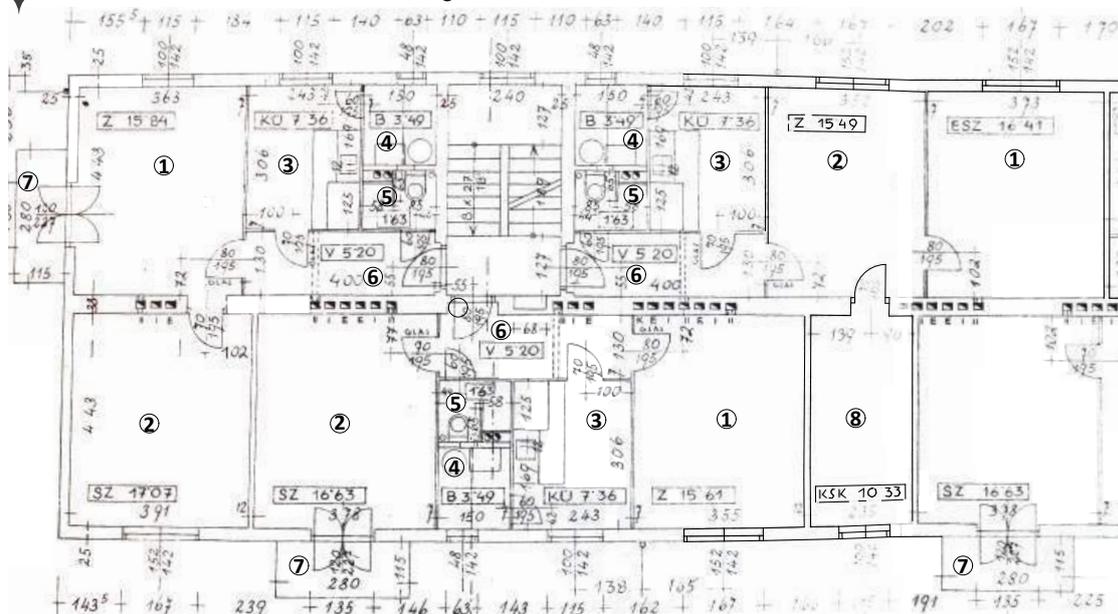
Grundrisstyp 1 von Eugen Wörle für Bauabschnitt 1
